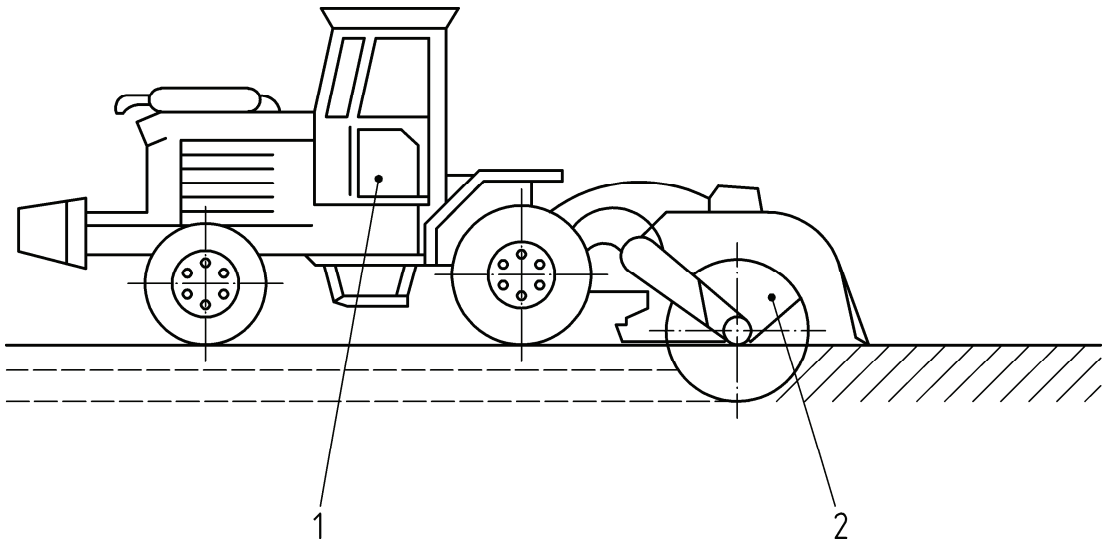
Bodenstabilisierungsmaschine mit mittigem horizontalem Rotor, basierend auf einem Grader
